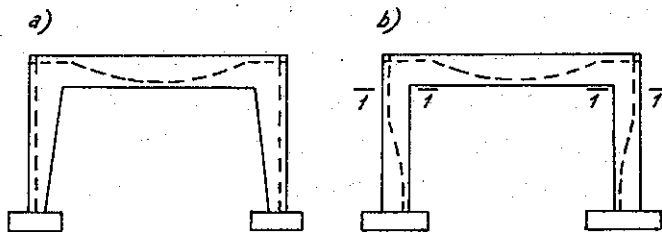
Bố trí cốt thép căng trước ở góc khung
